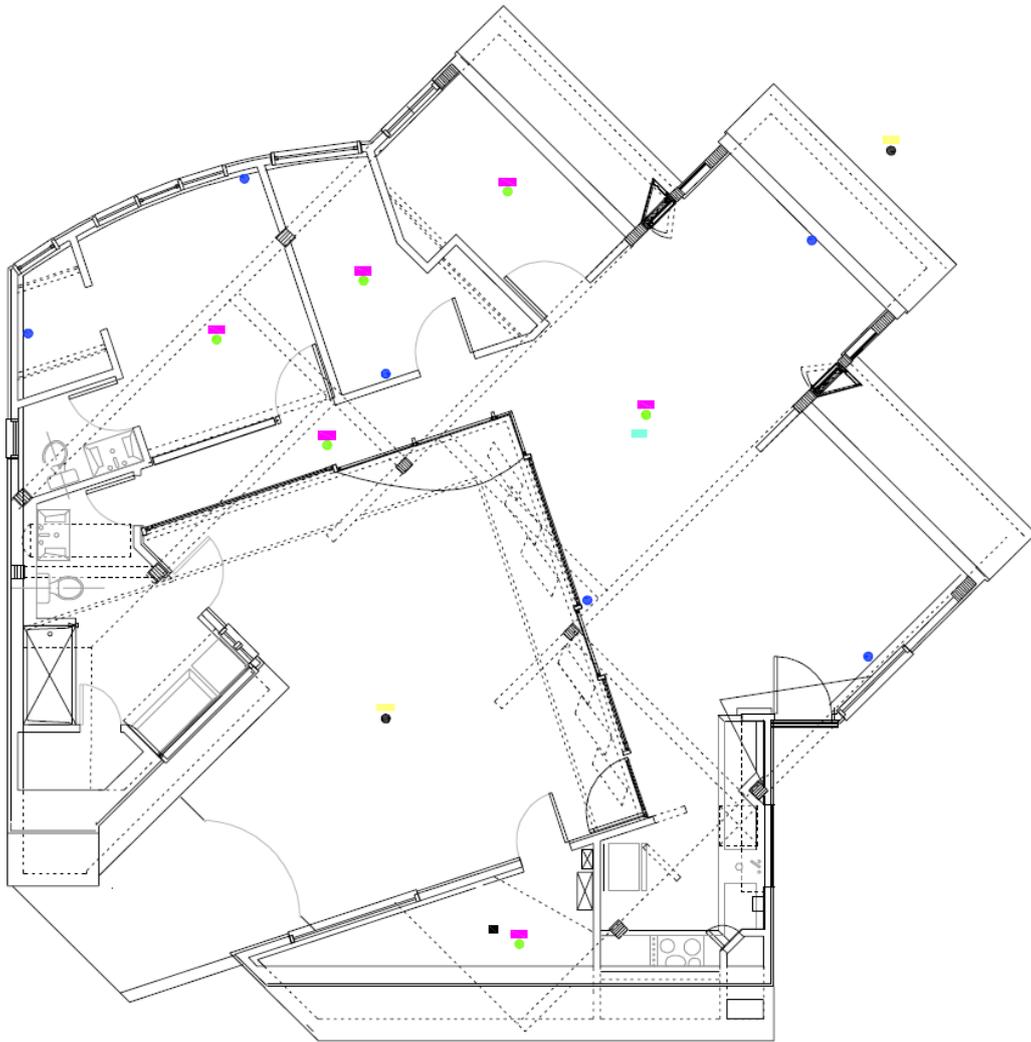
Situación en planta de los sensores de la vivienda 25 El Cangrejo
